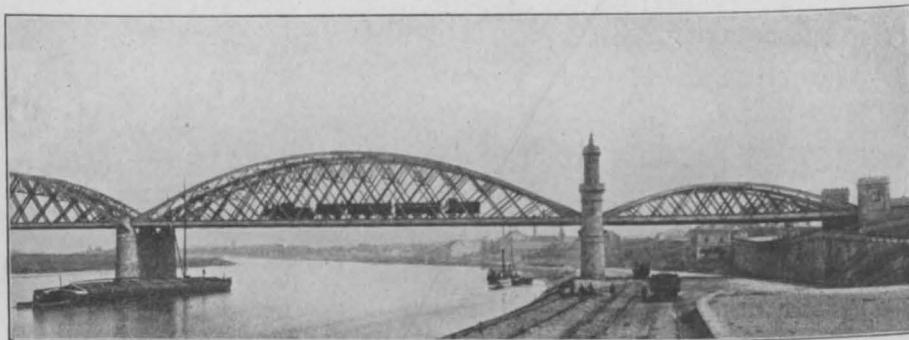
Eisenbahn- und Straßenbrücke über die Elbe bei Riesa. KÖPCKE. 1877—1878.
